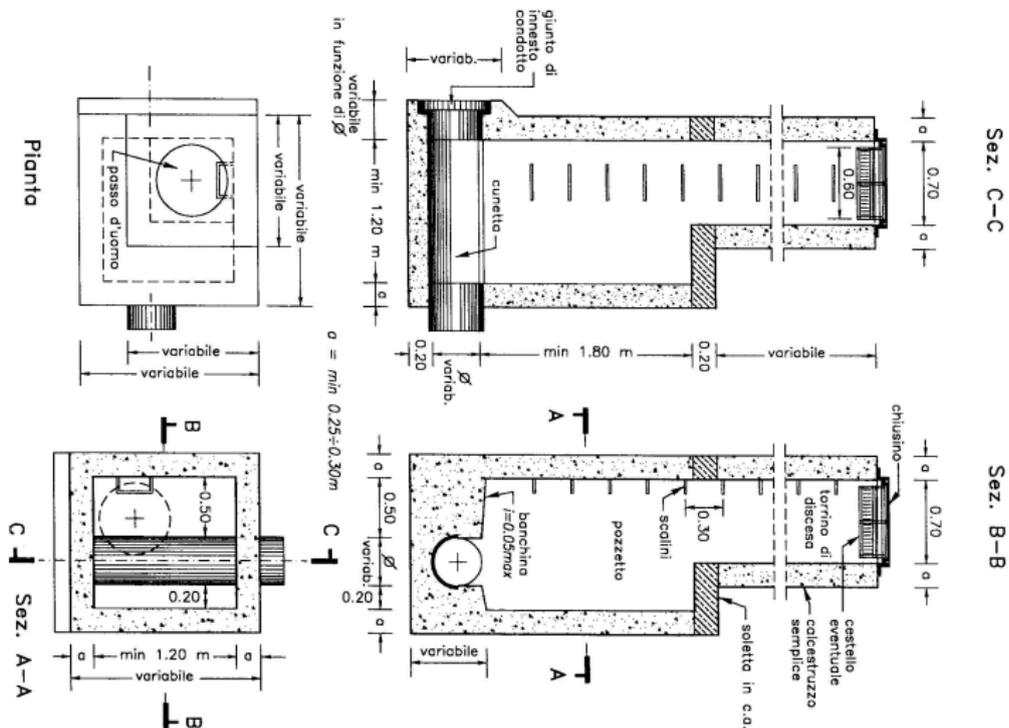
Pozzetto in cls per condotti a sezione circolare di piccolo diametro.
